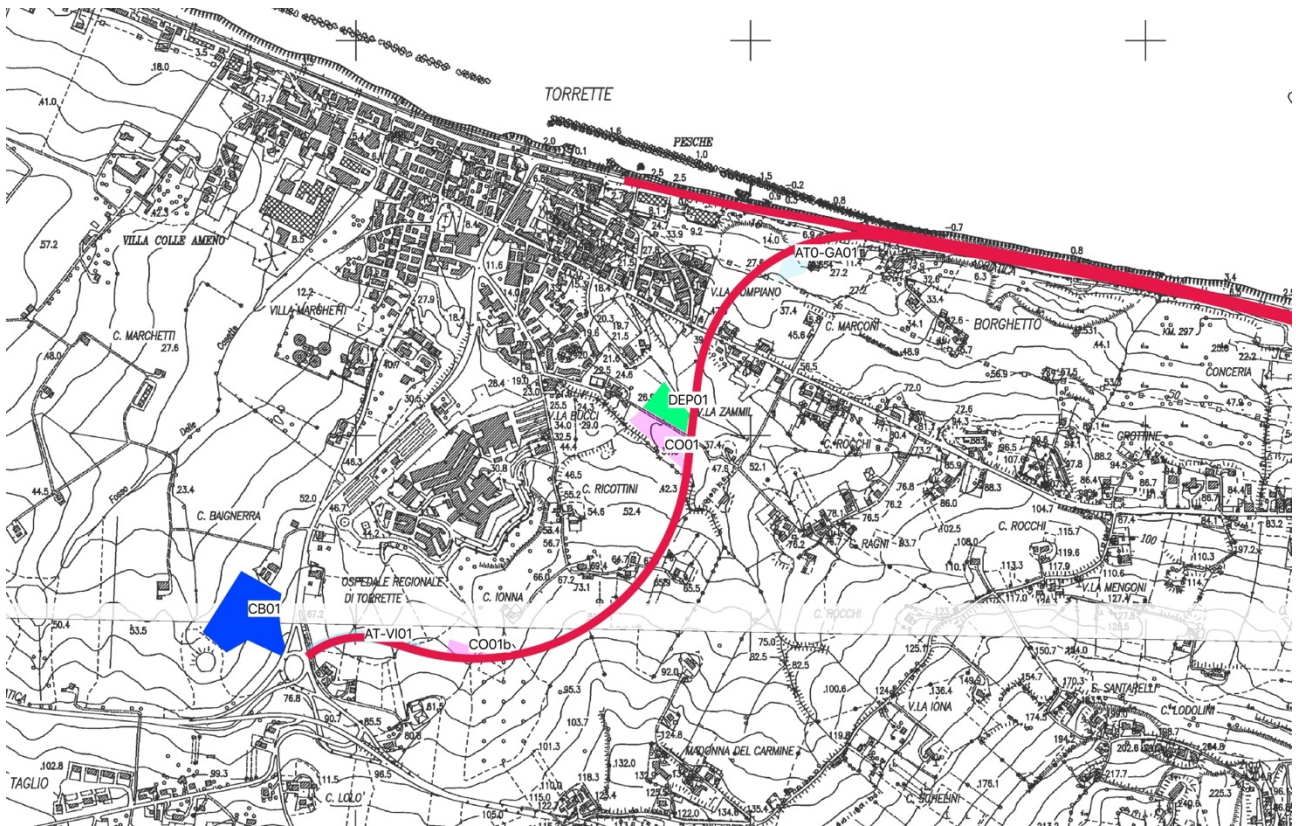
a – distribuzione generale delle aree di cantiere
